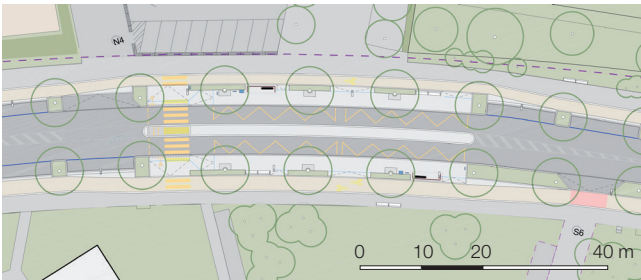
Plan Bushaltestelle (Atelier ADR)
